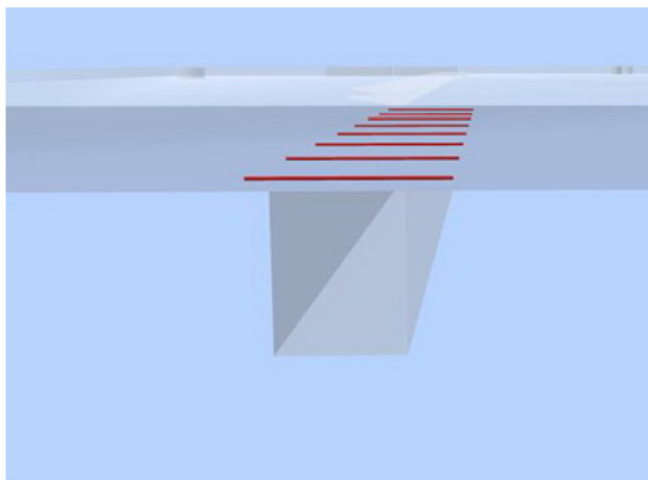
Раскладка поддерживающих кусков арматурных стержней над углублениями под балки (ригеля) в опалубке
